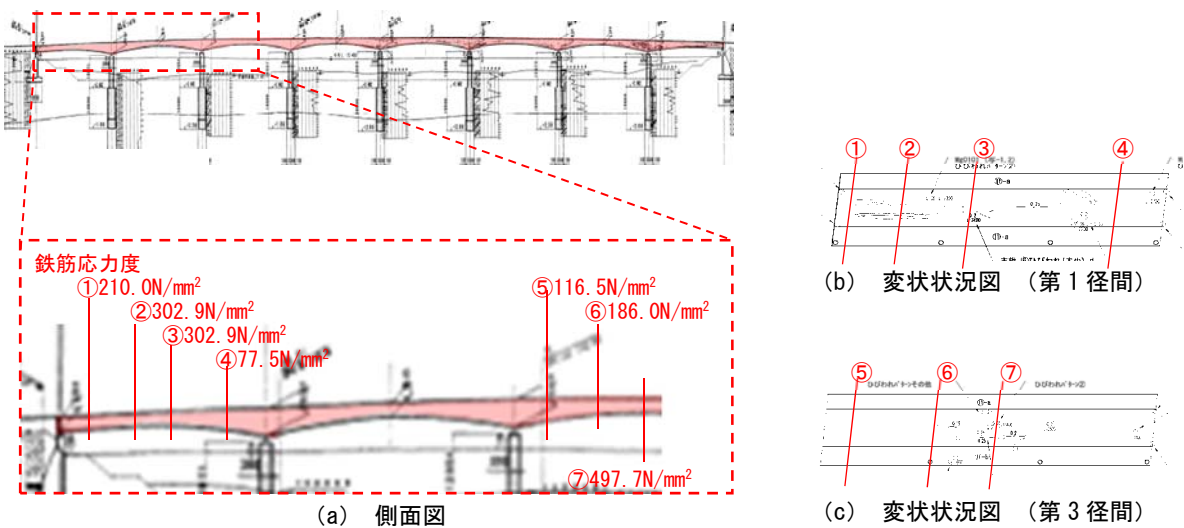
鉄筋応力度及び算出断面位置 (橋梁 No. 24)
